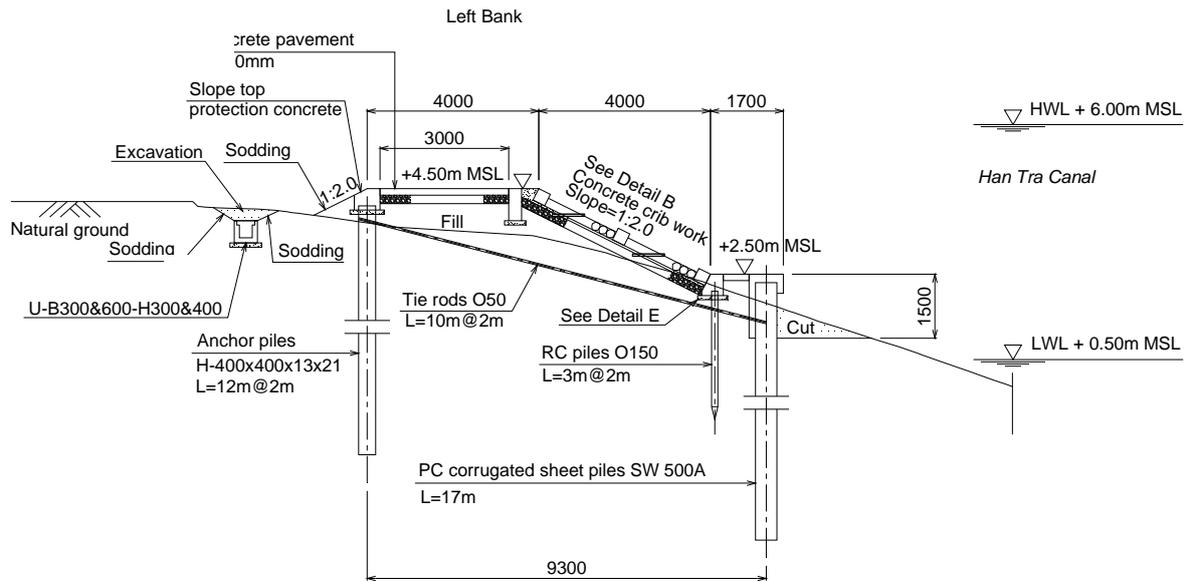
ハントラ水門下流護岸工標準断面図
